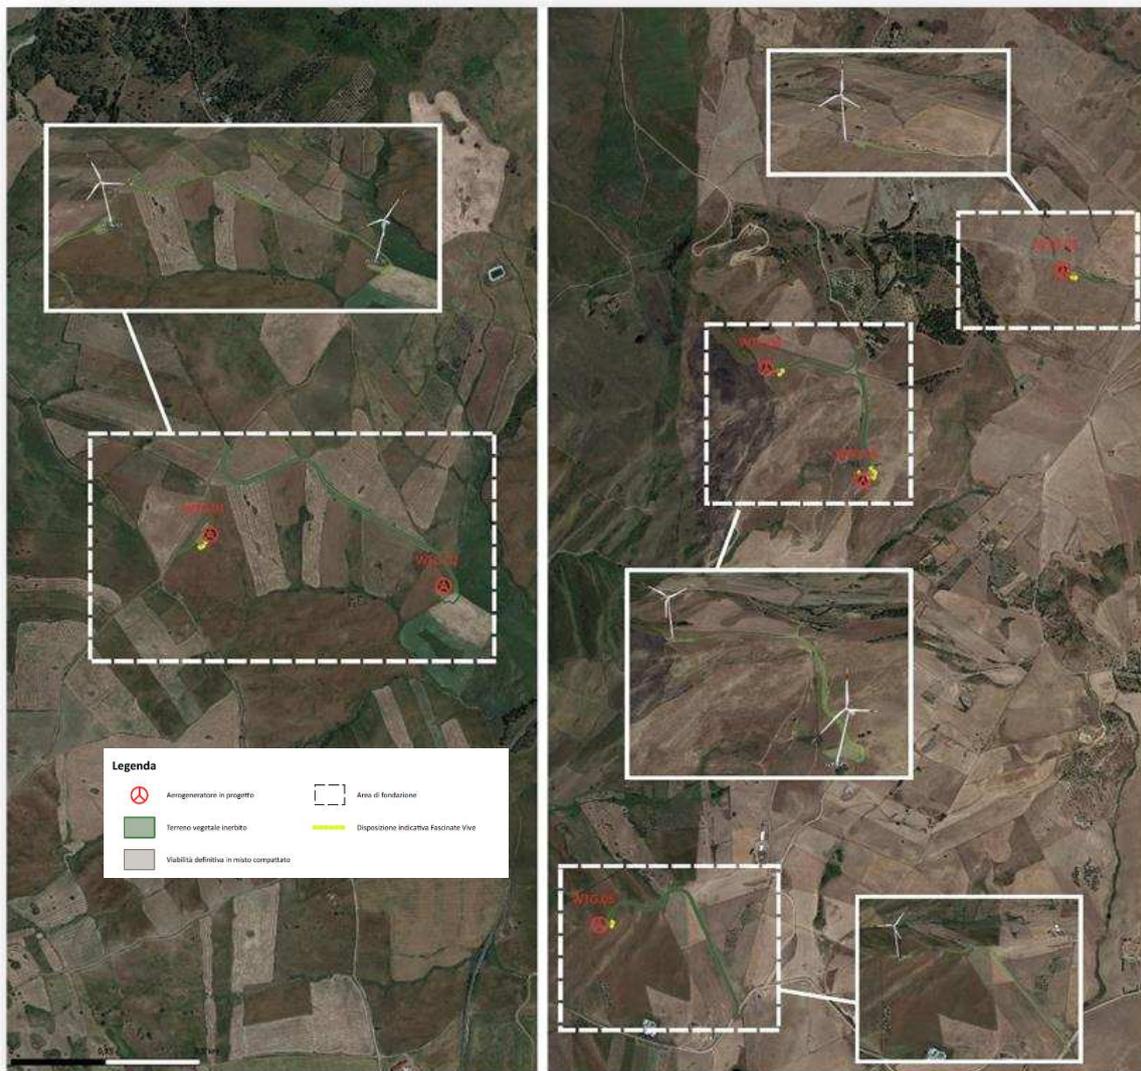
Estratto elaborato EDP0060 (Planimetria della sistemazione finale del sito)
